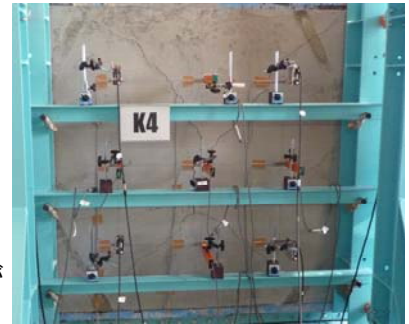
水圧载荷試験による試験扉体のひび割れ状況
